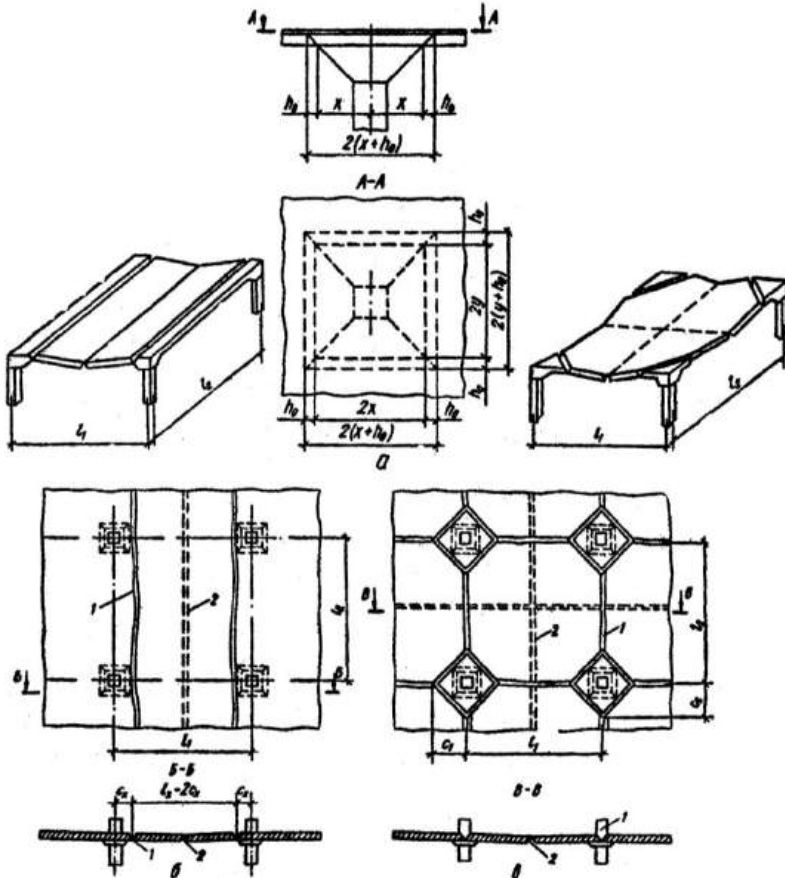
До розрахунку безбалкового перекриття: *a* – на продавлювання; *б* – схема утворення лінійних пластичних шарнірів при смуговому навантаженні; *в* – те саме, при суцільному завантаженні; *1* та *2* – розкриття пластичних шарнірів відповідно по верху та по низу
